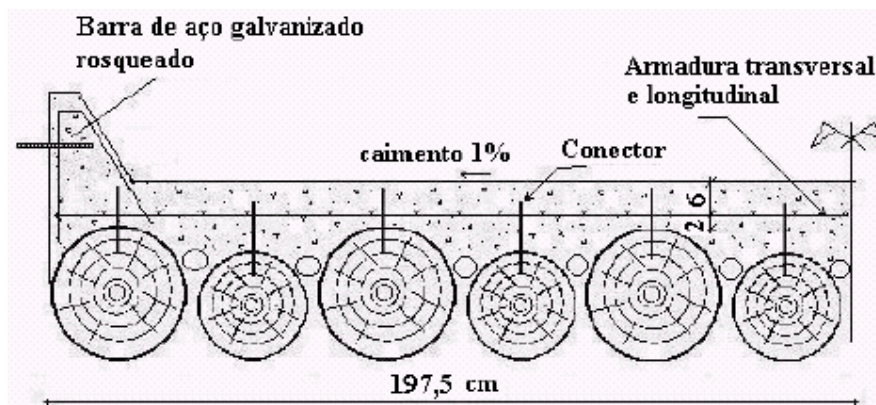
Seção transversal adotada para a Ponte Florestina destacando o nivelamento das vigas pela parte inferior. *Fonte: PIGOZZO (2004)
